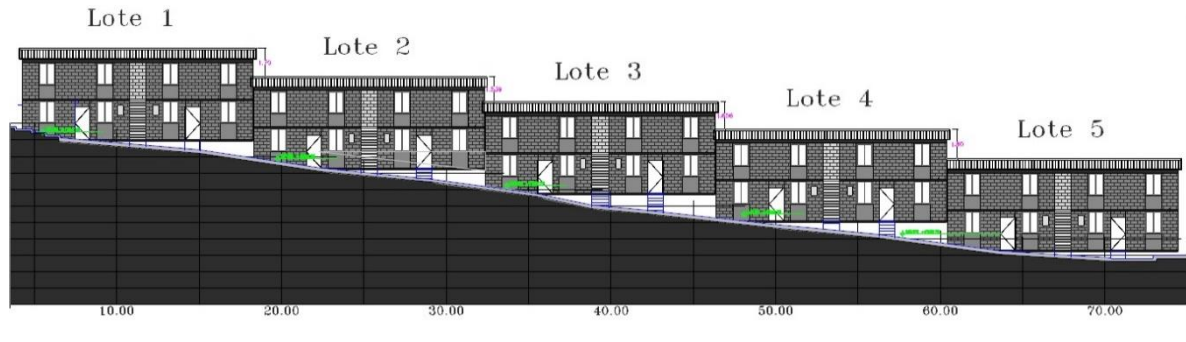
Fachadas de las viviendas bifamiliares con contorno topográfico
